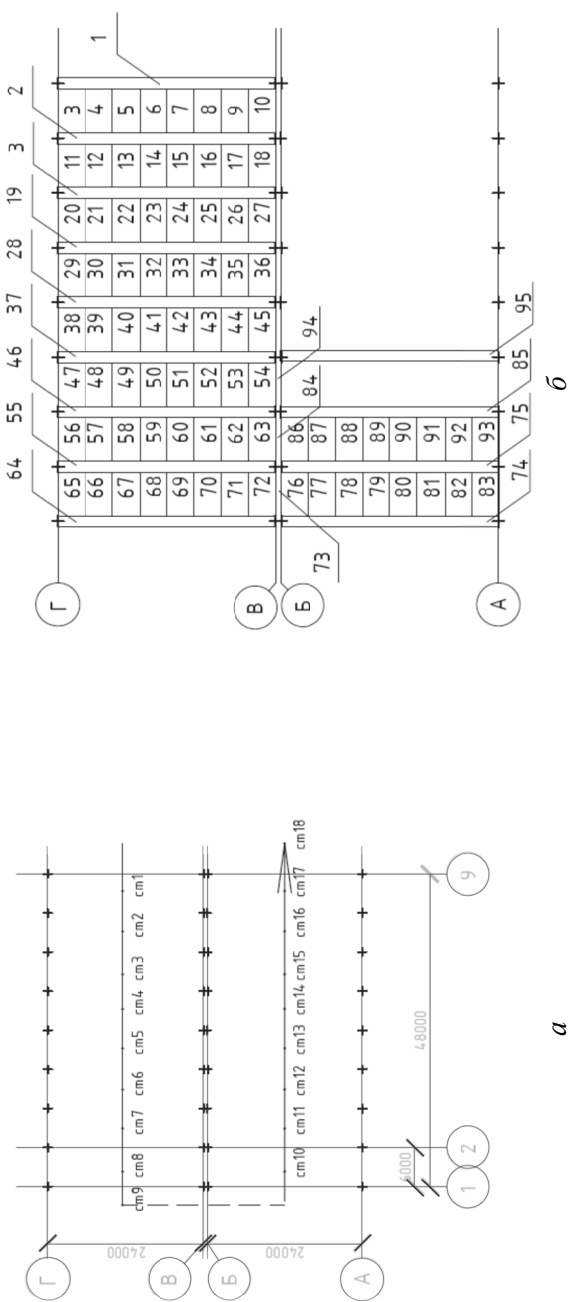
Монтаж элементов покрытия: а – схема проходки крана в пролетах шириной 24 м;
